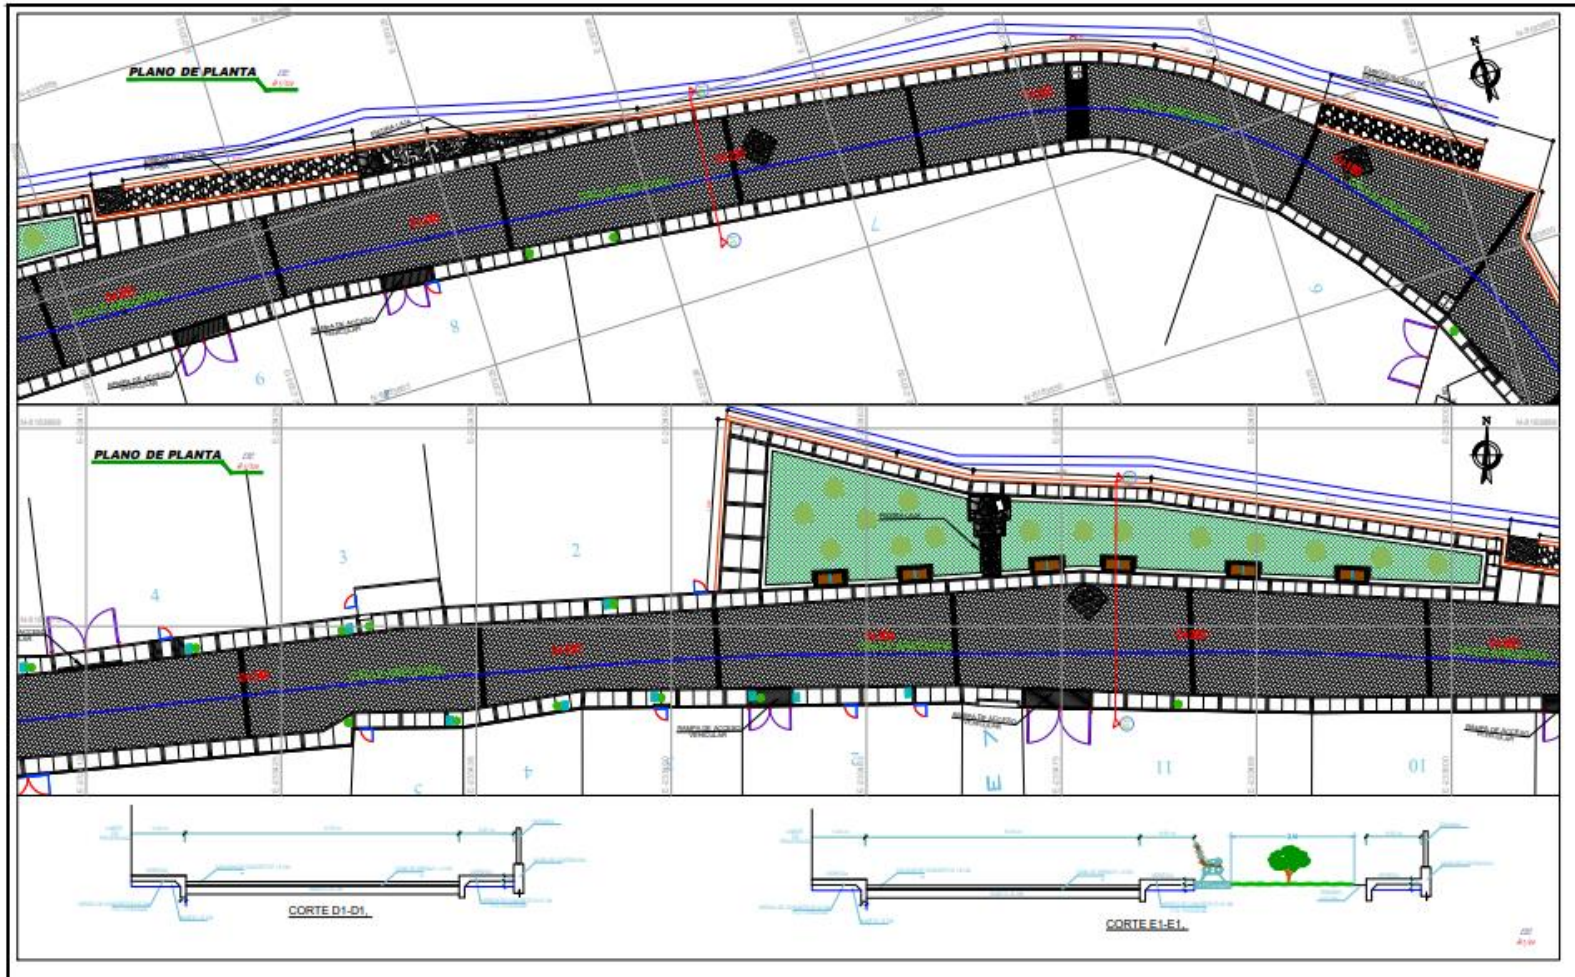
Planimetría de la construcción de muros de contención Tramo 2. A1.
